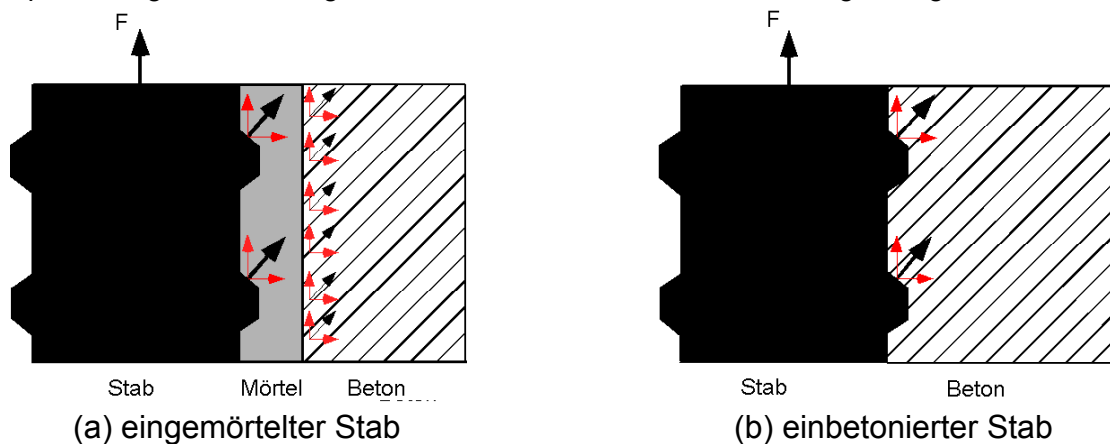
Schematische Darstellung der Spaltkraftentwicklung bei einbetonierten und eingemörtelten Bewehrungsstäben
